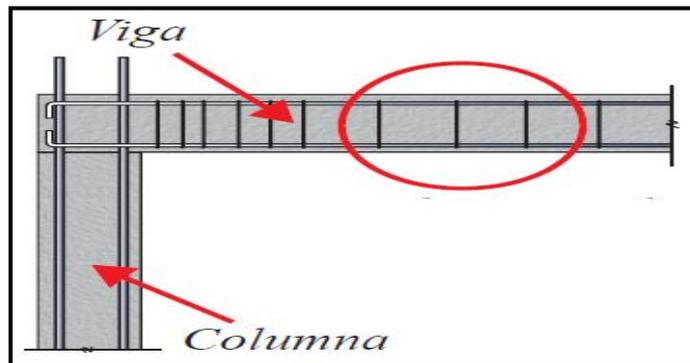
Detalle estructural de una viga de concreto armado.
